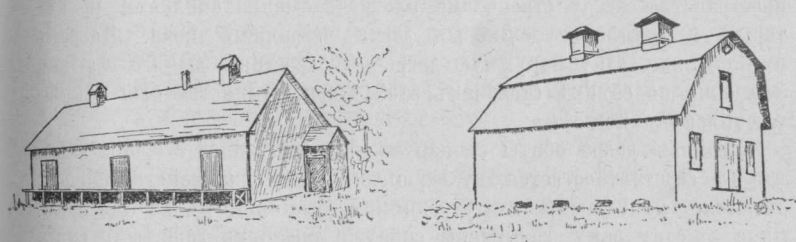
Плодохранилище въ Нов. Шотландіи. Рис. 34. Плодохранилище Уильсона.
